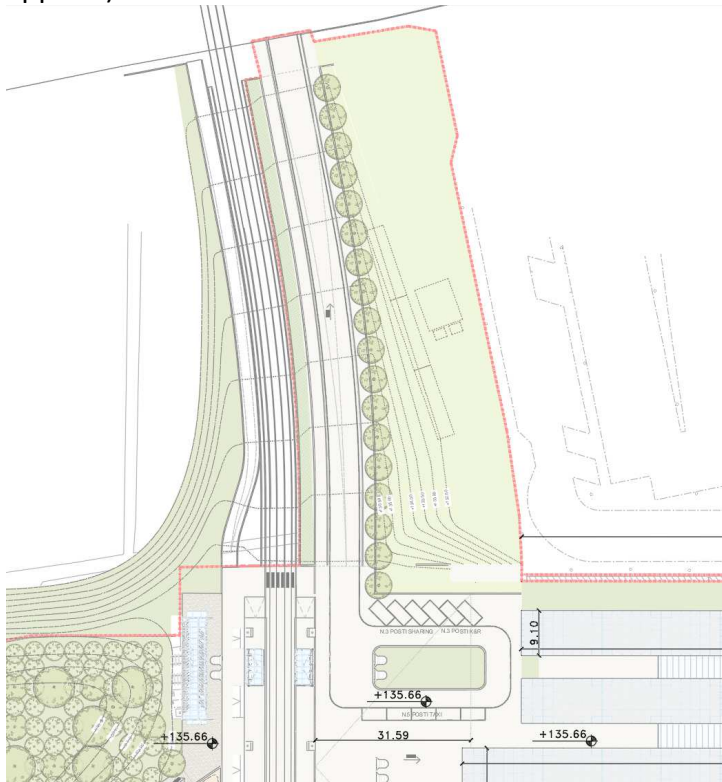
Estratto planimetria di inquadramento dell'ingresso est in fase 2. (lato nord)
